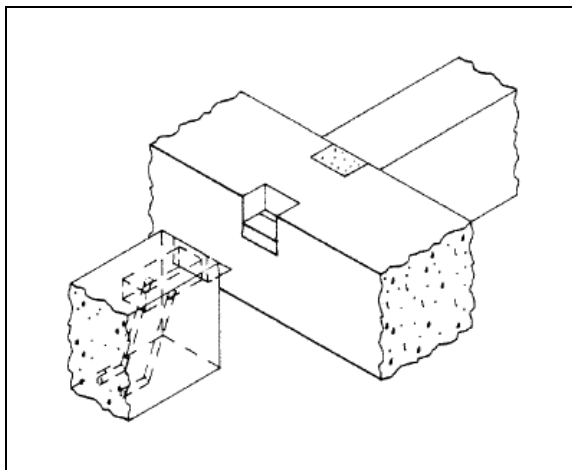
Ligação por consola curta metálica com armaduras em gancho (Sidney, 2000)
